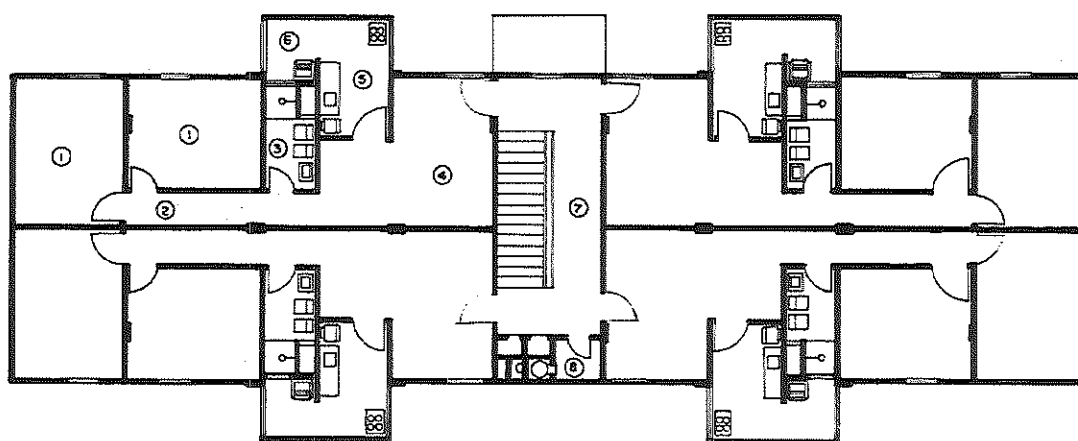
Planta-baixa do andar tipo - Conjunto General Luís de França
